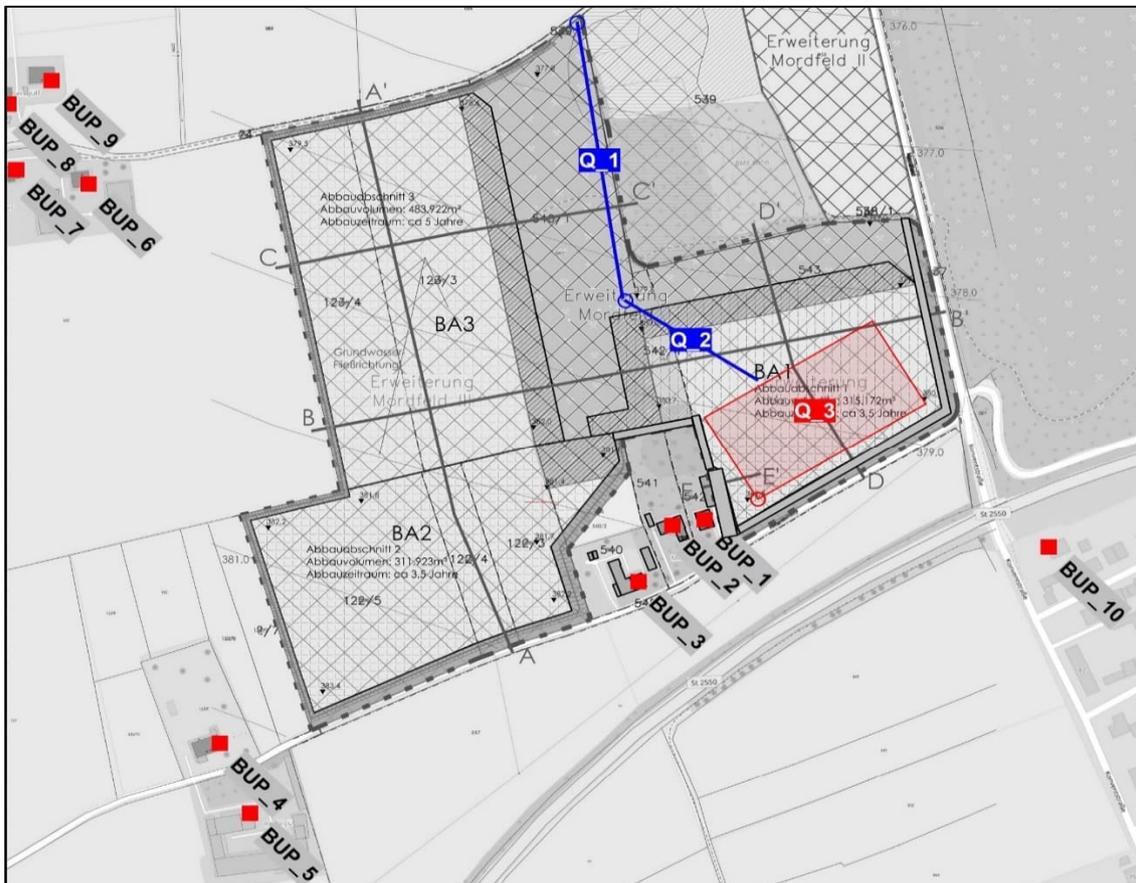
Lageplan mit Darstellung der Emissionsquellen Variante 1
